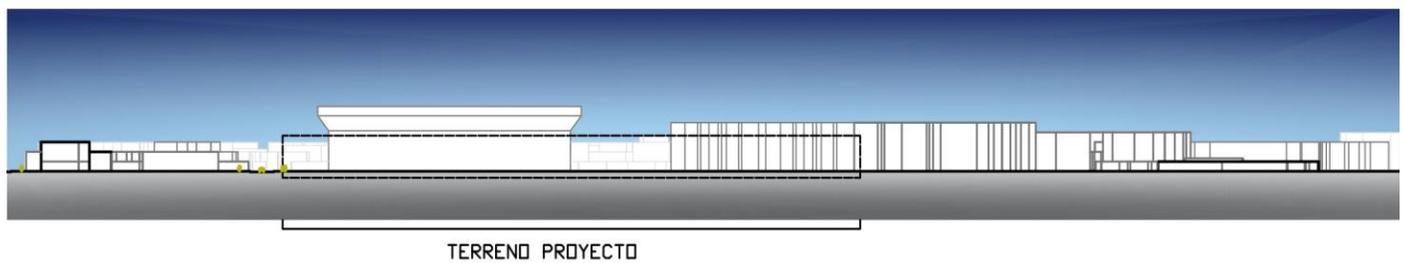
Corte transversal B-B'. Elaboración grupal taller avanzado.
